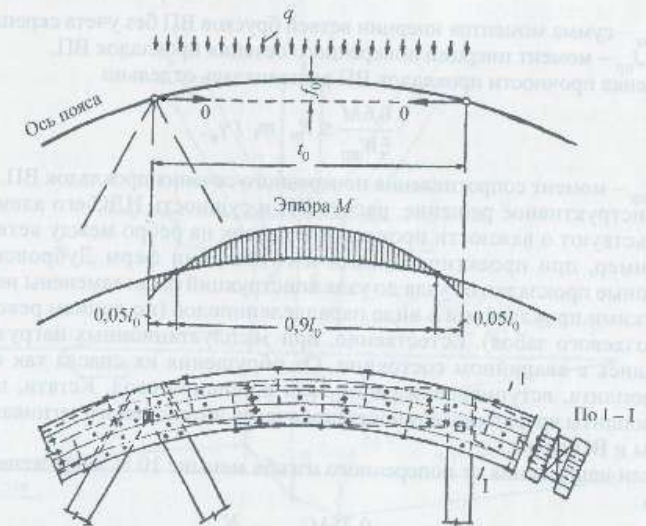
Расчетная схема и конструкция ВП сегментной фермы
